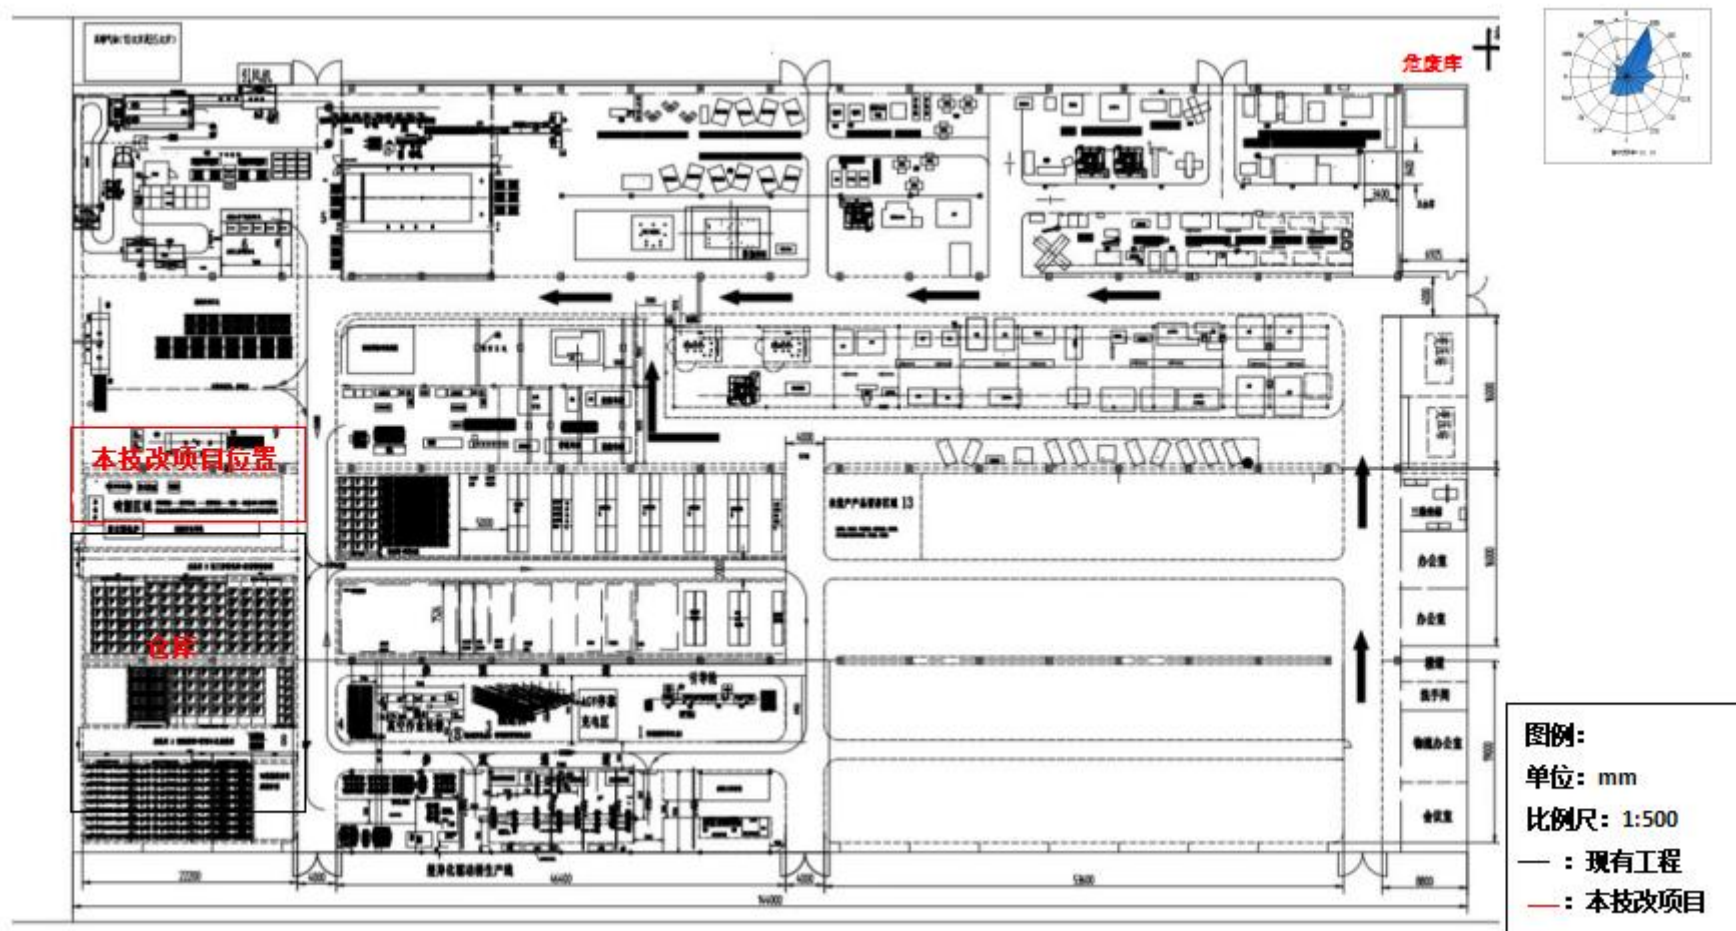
临沂金盛机械配套有限公司厂区平面布置图
